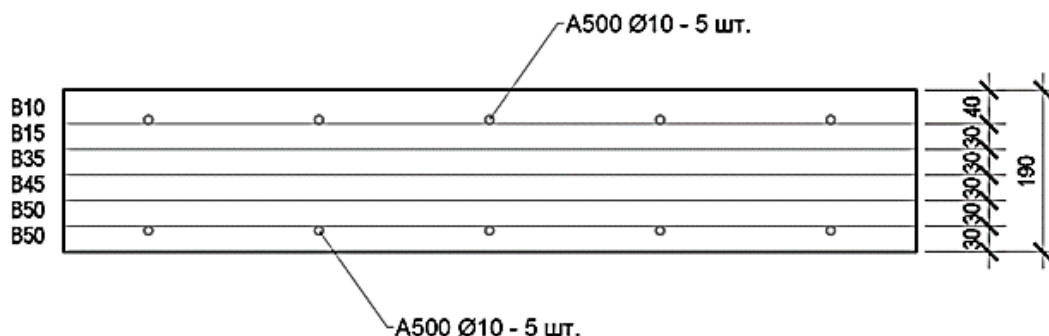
Поперечний переріз плити перекриття зі змінним класом бетону за товщиною
